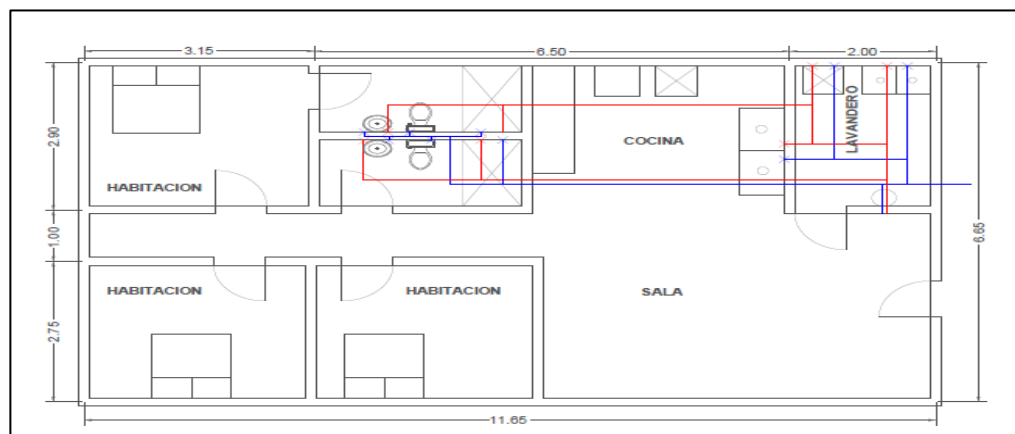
Plano de planta del apartamento, Agua fría y Agua caliente.
